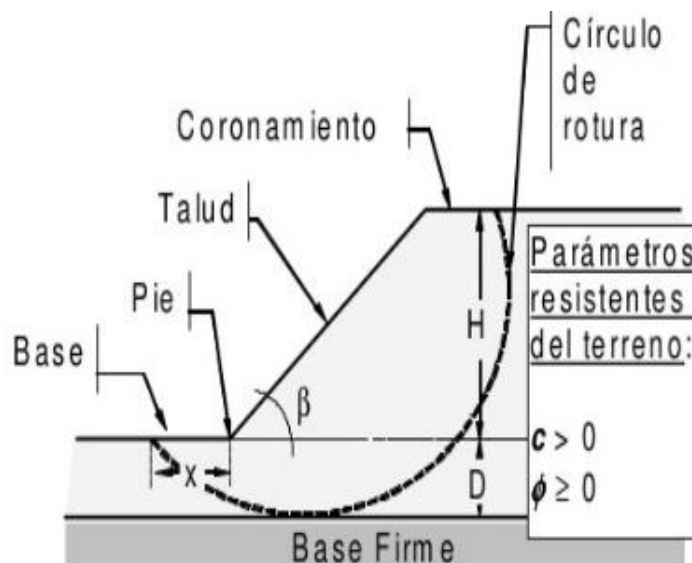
Partes de un Talud. Fuente: ABC Geotechnical Consulting
